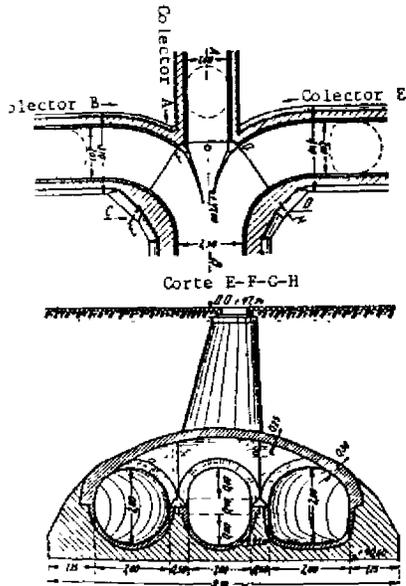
13: Empalmes para alcantarillas de gran dimensión
